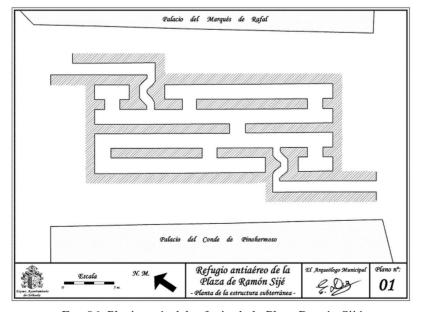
Planimetría del refugio de la Plaza Ramón Sijé
